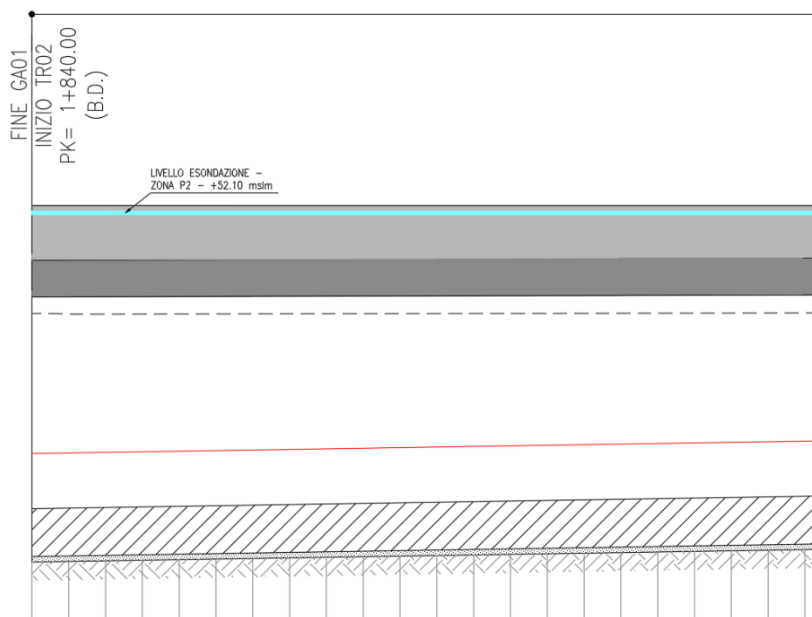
Profilo longitudinale TR02 – Imbocco galleria Nord BD
